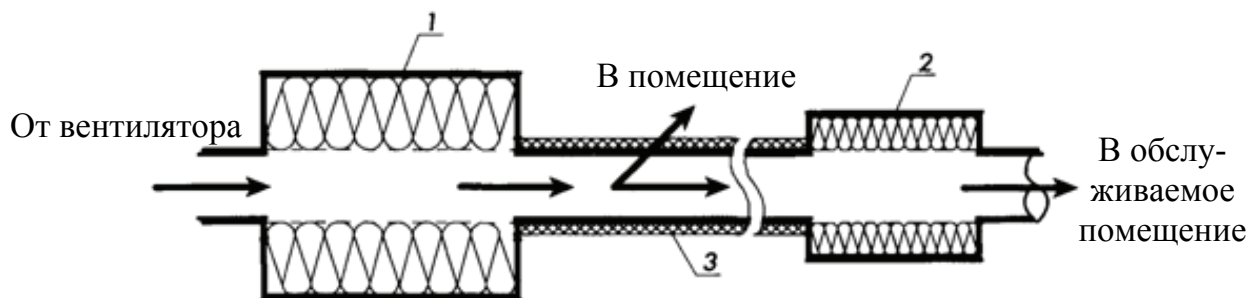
Схема фрагмента вентиляционной сети: 1 – транзитный глушитель; 2 – глушитель конечного участка сети; 3 – транзитный воздуховод со звукоизолирующей облицовкой
